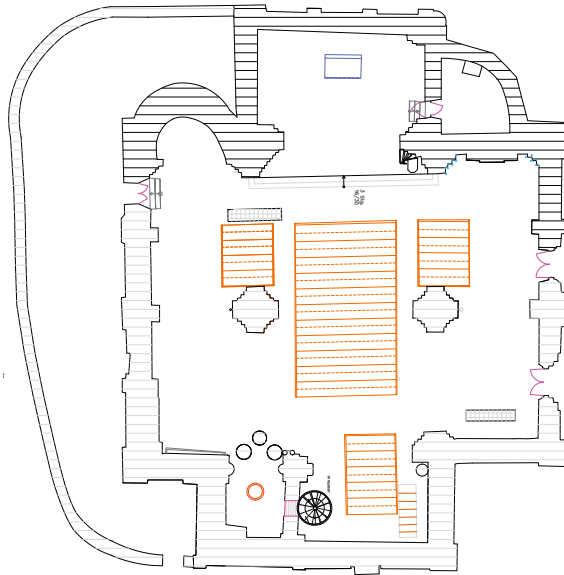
Hohnekirche Soest, Grundriss. © Dipl.-Ing. Achim Zickwolf, Soest
